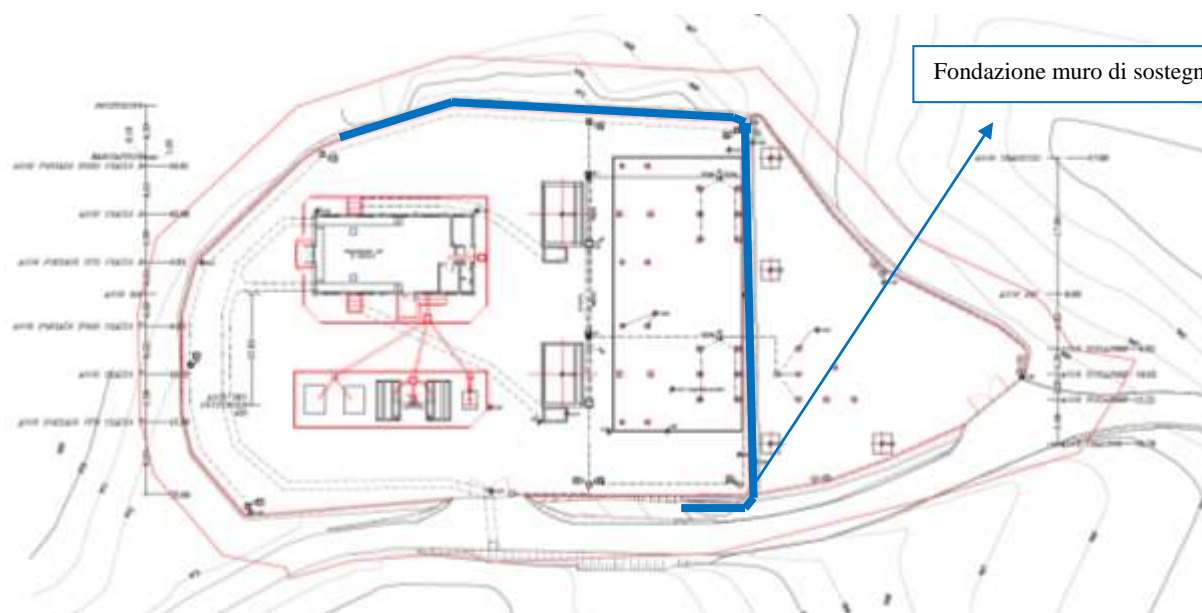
Sviluppo planimetrico della fondazione del muro di sostegno.
